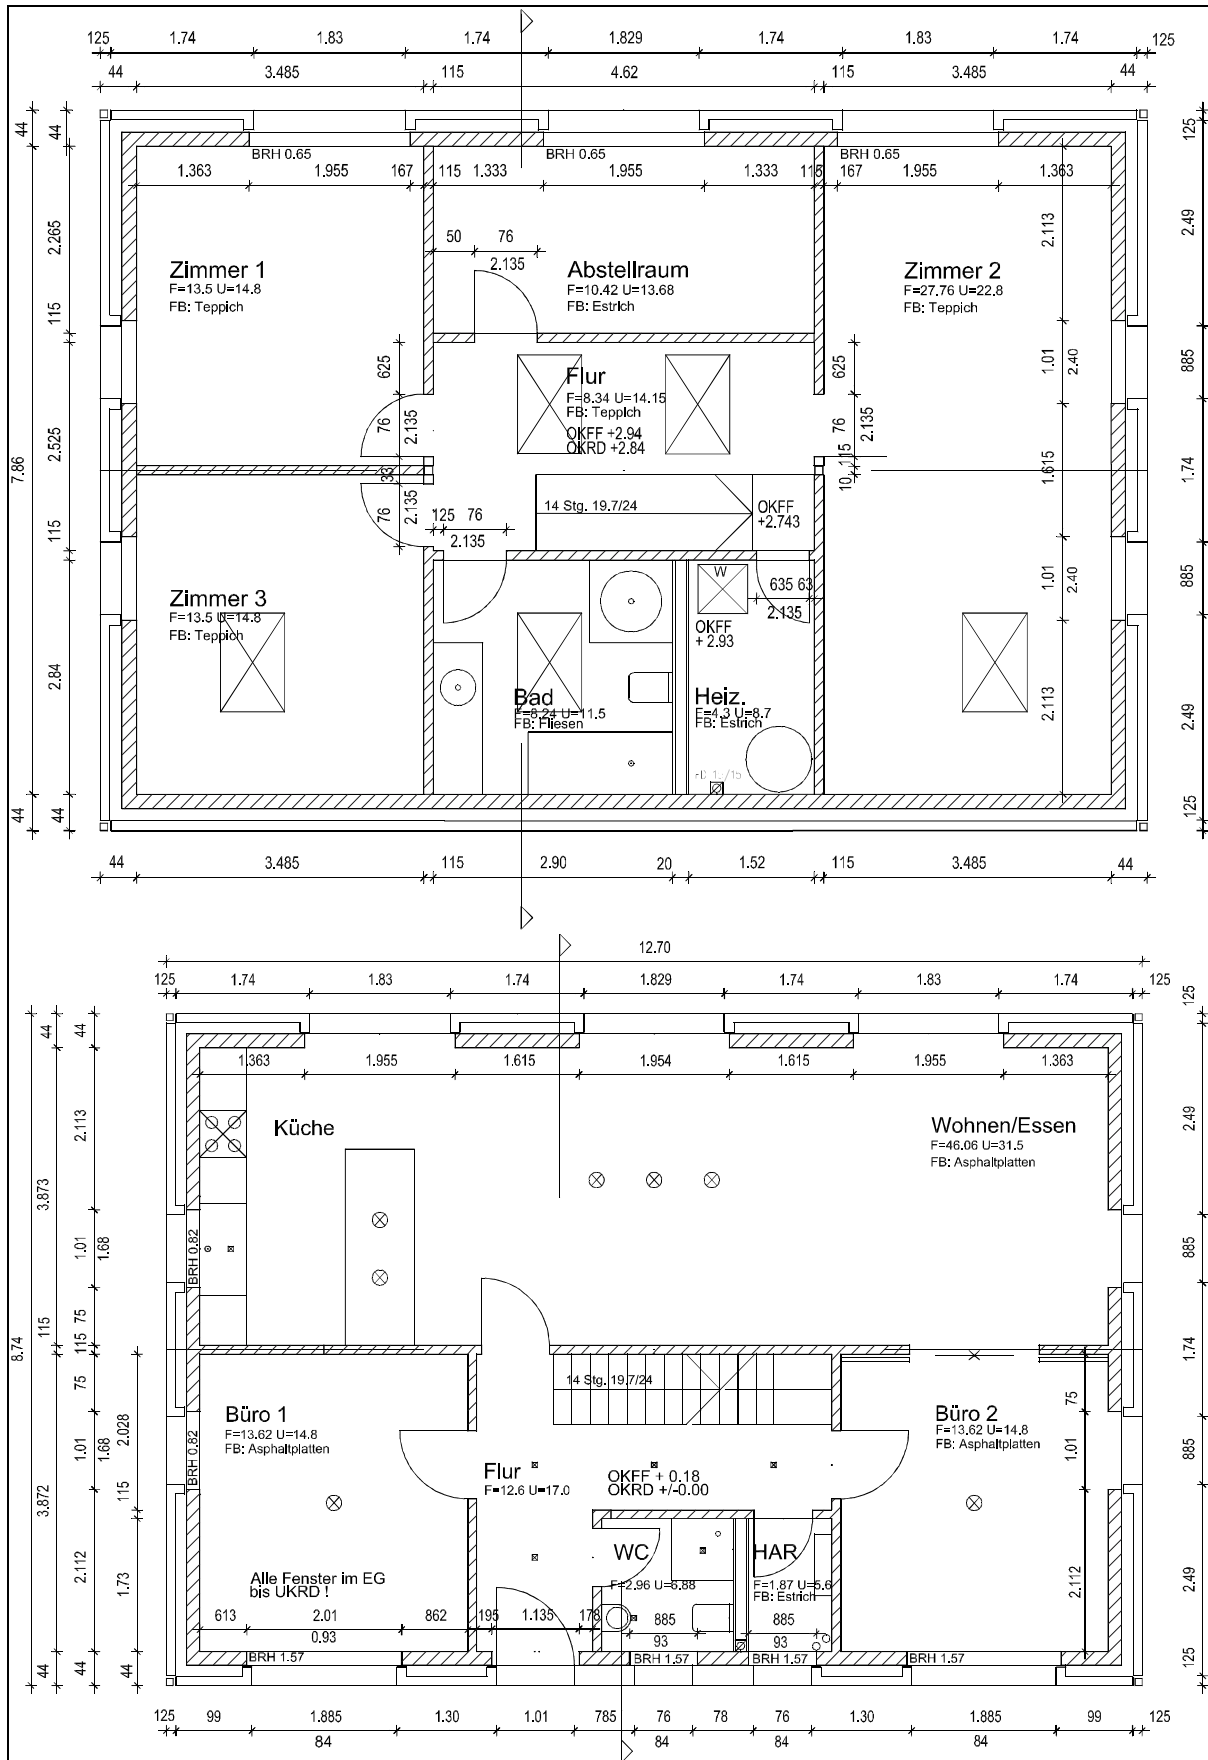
Grundrisse des EFH (oben: Obergeschoss, unten Erdgeschoss) [KUKA Ordner]
